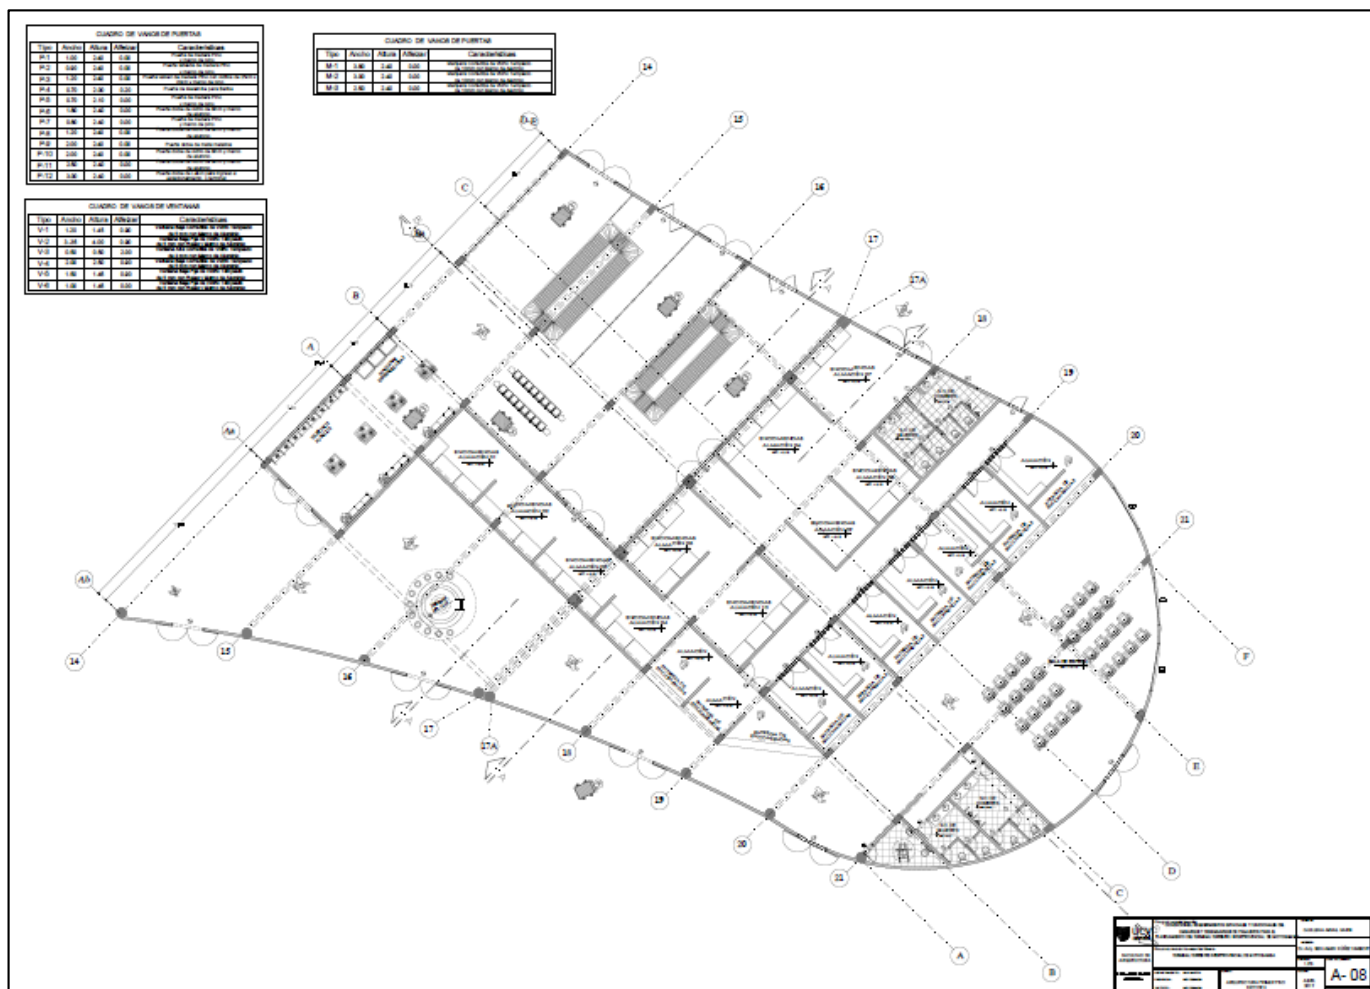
Plano bloque 3, Fuente: Elaboración propia.
